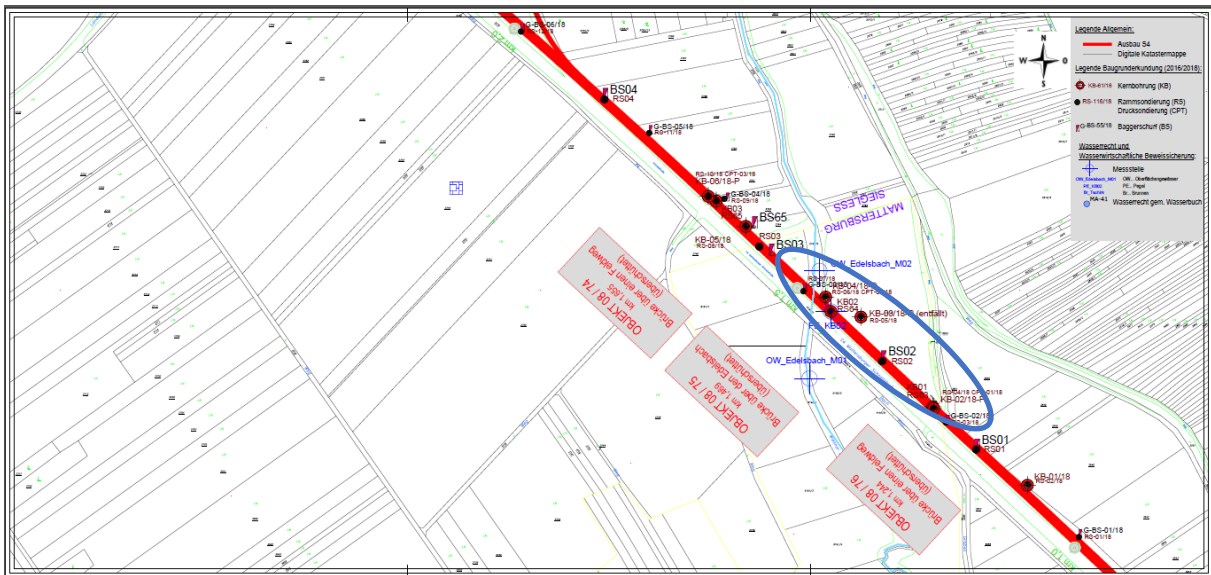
Kernbohrung 4 – Lageplan.
